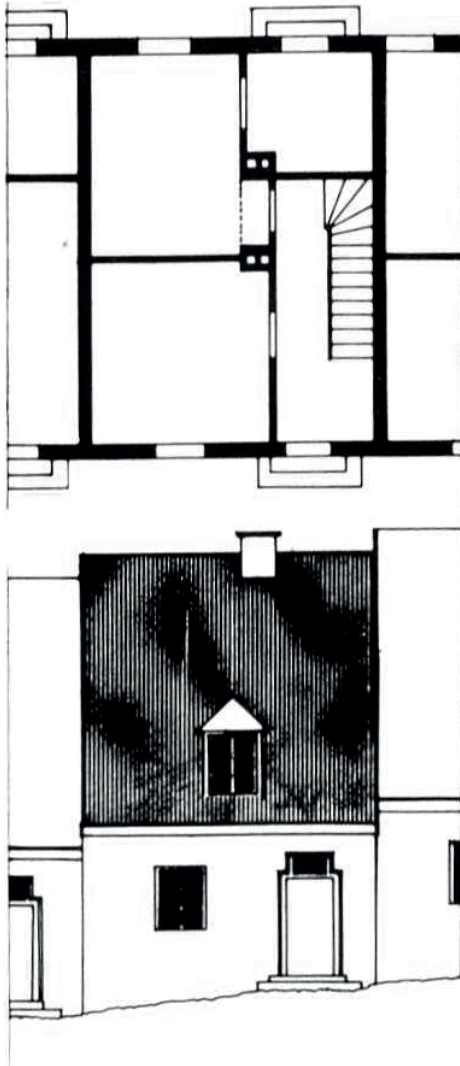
Bergdirektion Fohnsdorf, Auerling-Siedlung, o.J., Grundriss und Ansicht einer Wohnung
